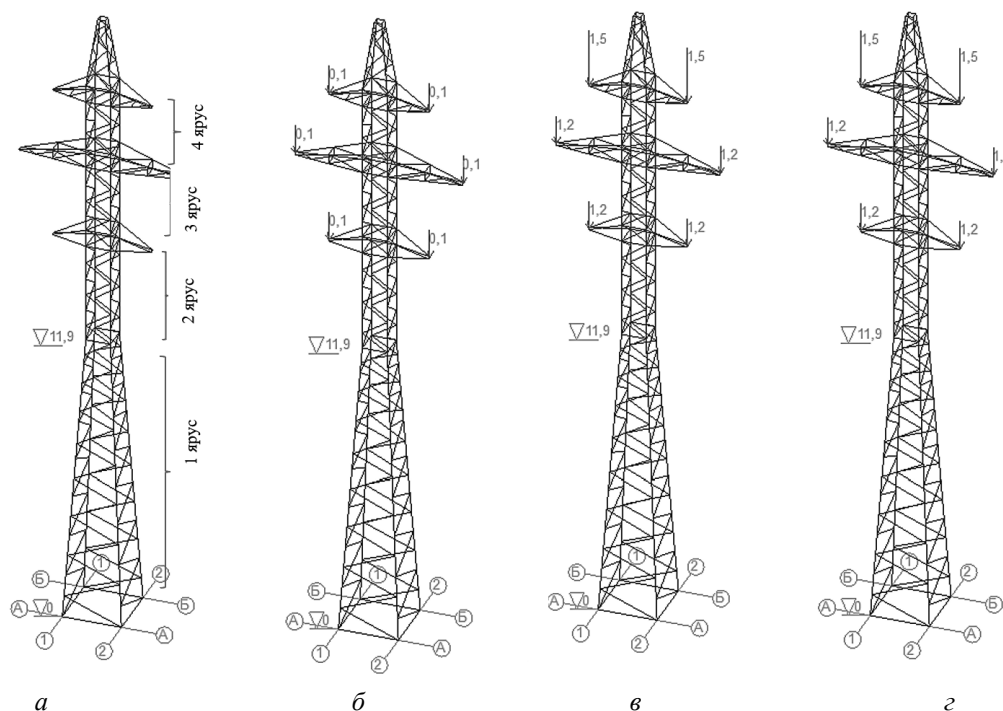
Схемы: а — вертикальный план ВЛЭП; б — расчетная схема; в-г — схемы загрузки опоры ВЛЭП
